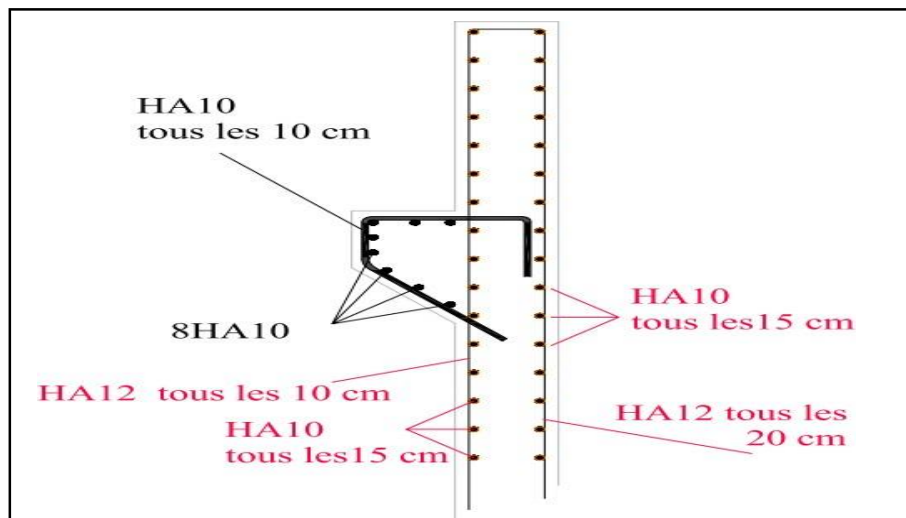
Ferrailage du mur de garde-grève et du corbeau d'appui
